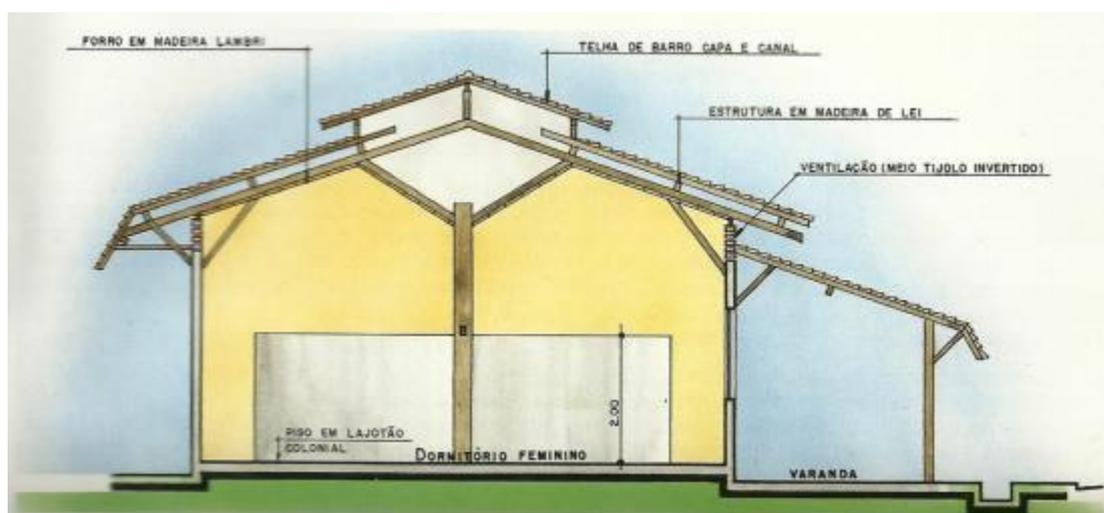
Corte esquemático de edificação do Retiro Tagaste. Fonte: Revista Projeto nº102.
